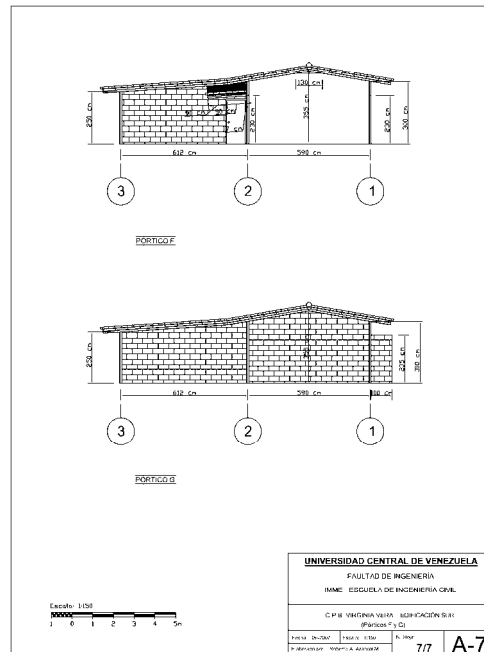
Plano A7: Plano Arquitectónico de los pórticos F y G
